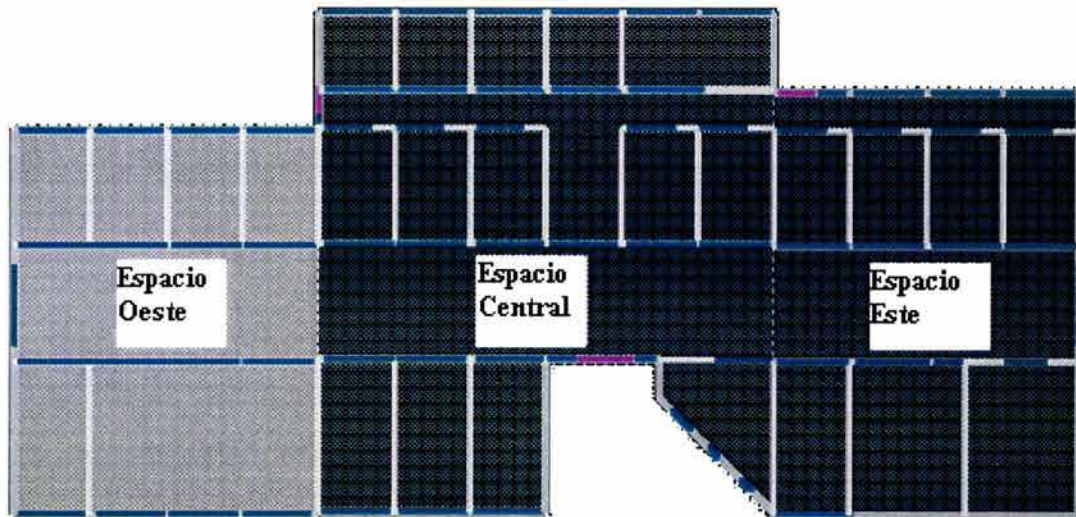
Planta de la edificación dividido en tres espacios.
